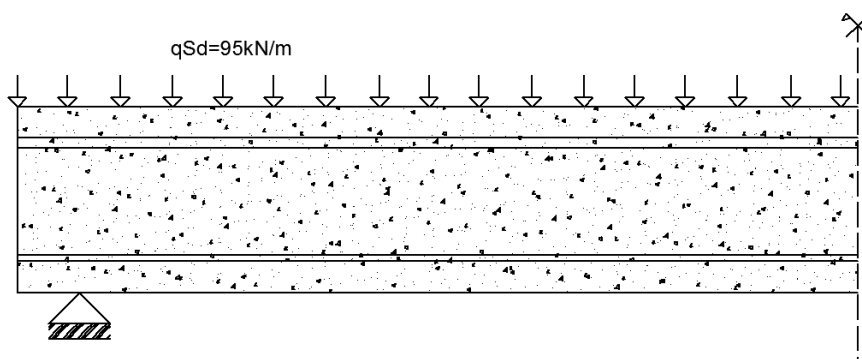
Vista lateral da viga de betão armado correspondente á secção transversal em I
